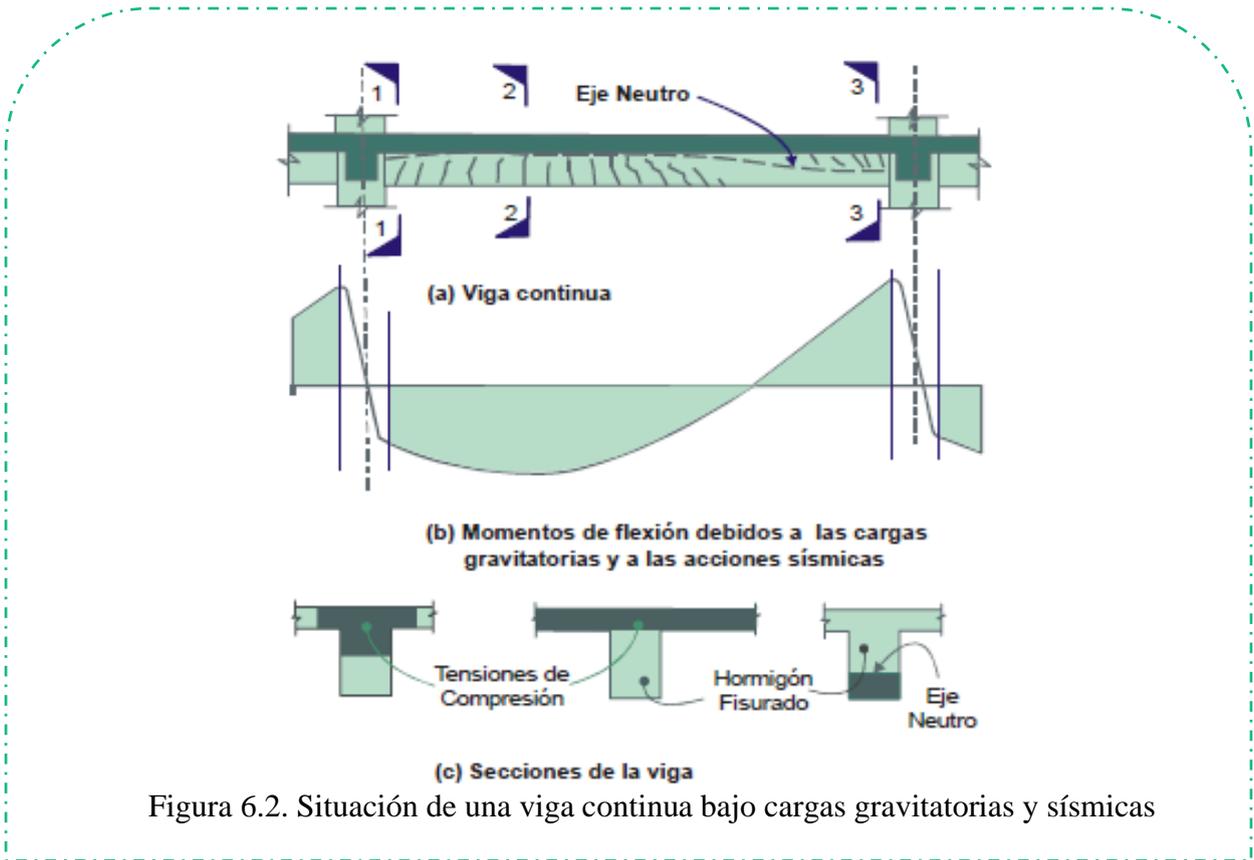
Situación de una viga continua bajo cargas gravitatorias y sísmicas
